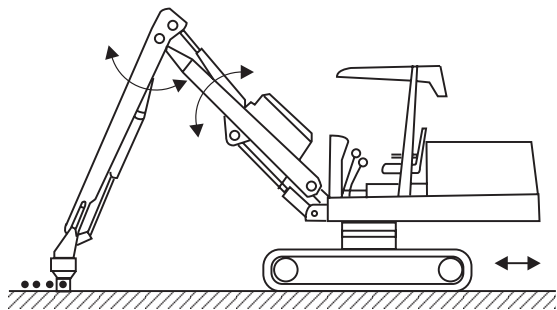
Манипулятор для горизонтальной укладки бетона
